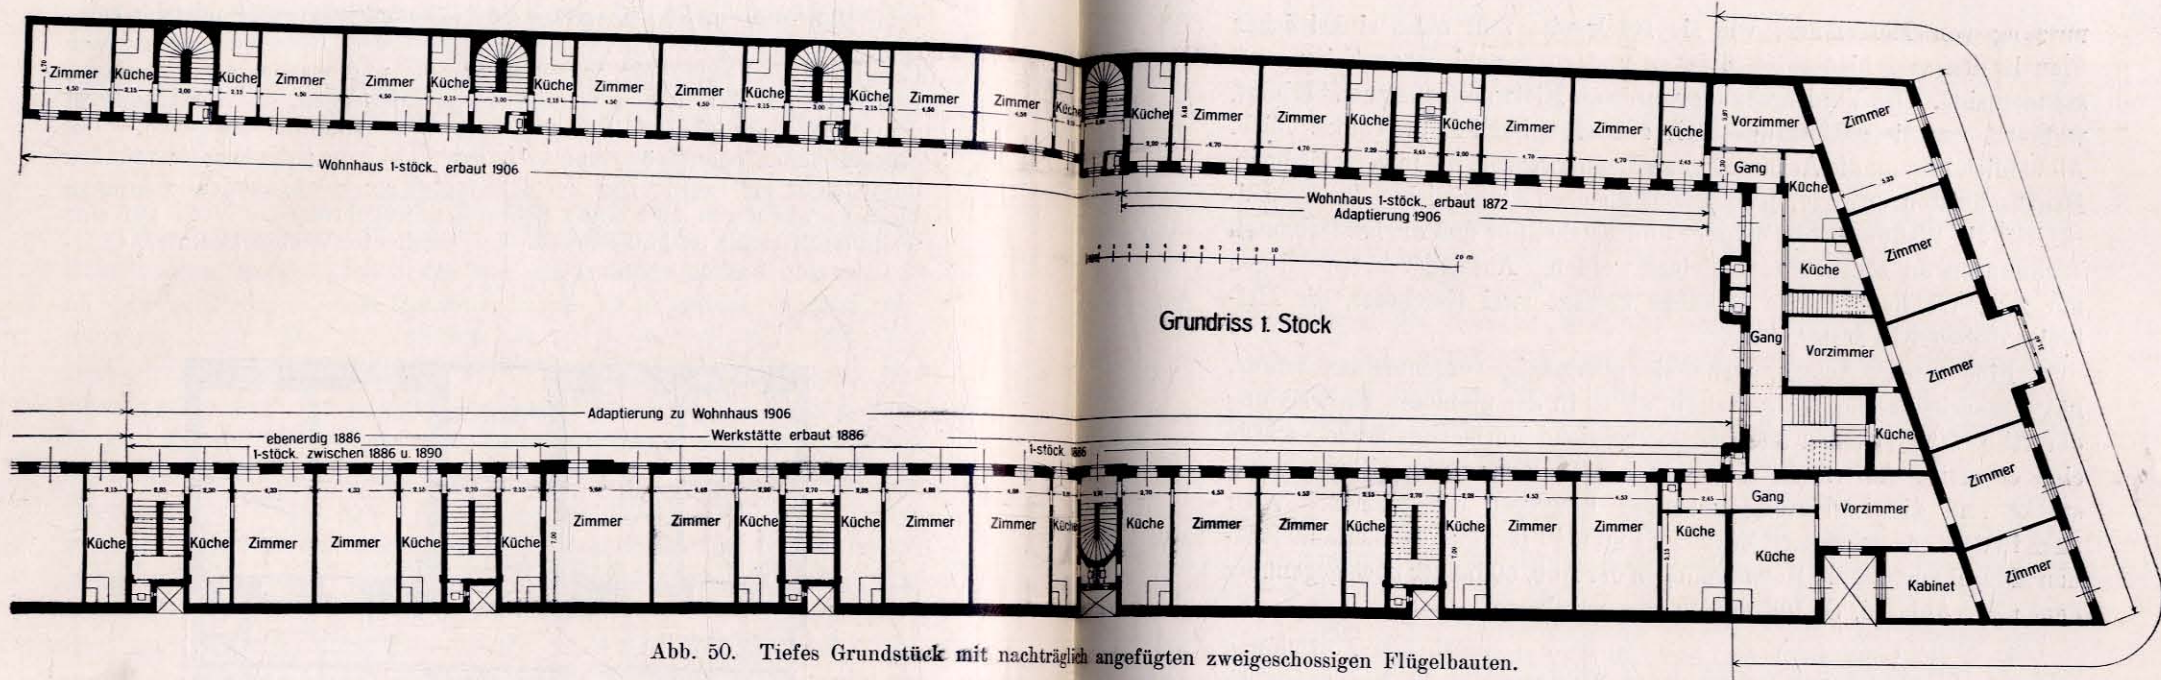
Tiefes Grundstück mit nachträglich angefügten zweigeschossigen Flügelbauten.
